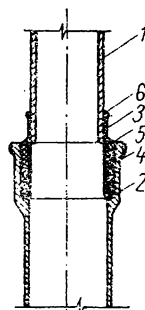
Îmbinarea cu tubulatură de alamă sau de cupru :
